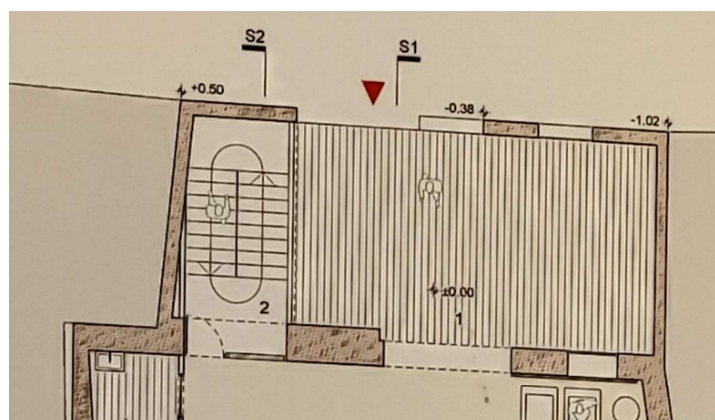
Detalle de zona de acceso a la planta baja por calle Costa de'n Macari nº 6 en PLANTA BAJA (escala 1:100) en la lámina 2/2 de la documentación presentada por el licitador
